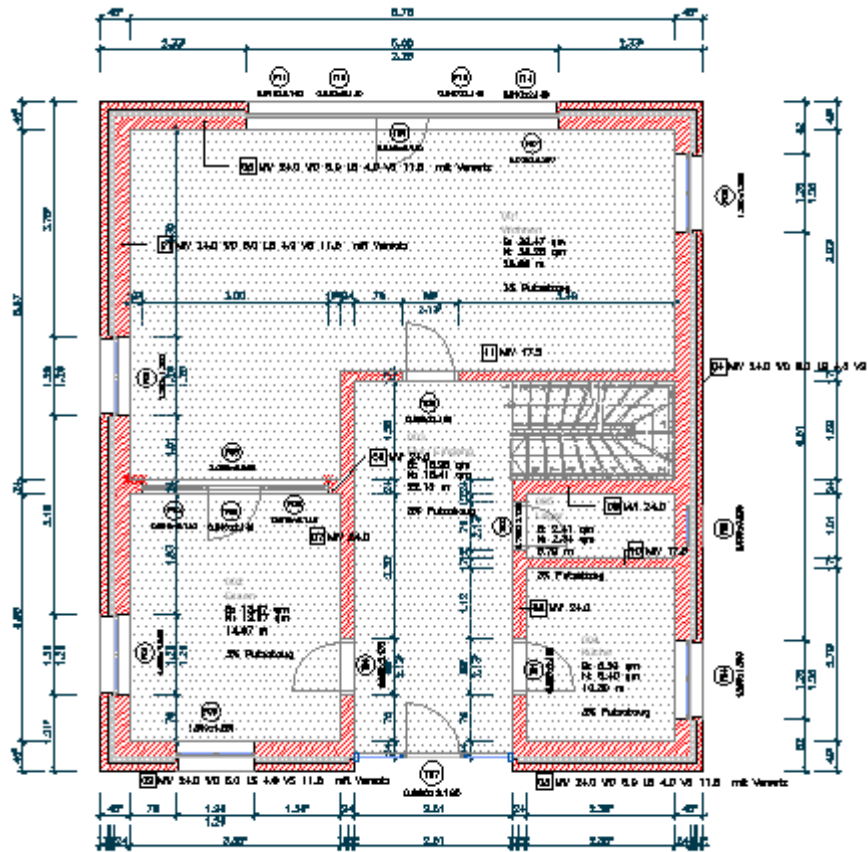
Beispielprojekt - Grundriss Erdgeschoss
